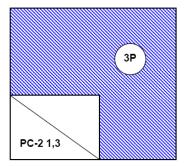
Esquema de porches y número de plantas arquitectónicas
